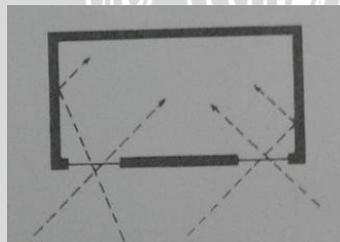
Macam-macam tipe pencahayaan samping (denah) dan contoh aplikasinya.
